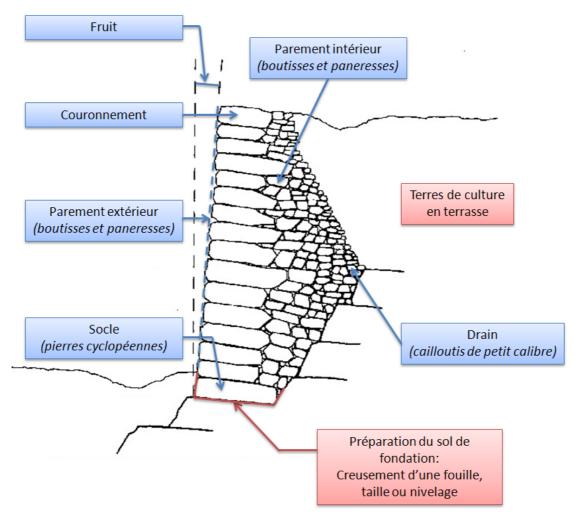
Structure d'un mur de soutènement en pierre sèche - Vue en coupe
